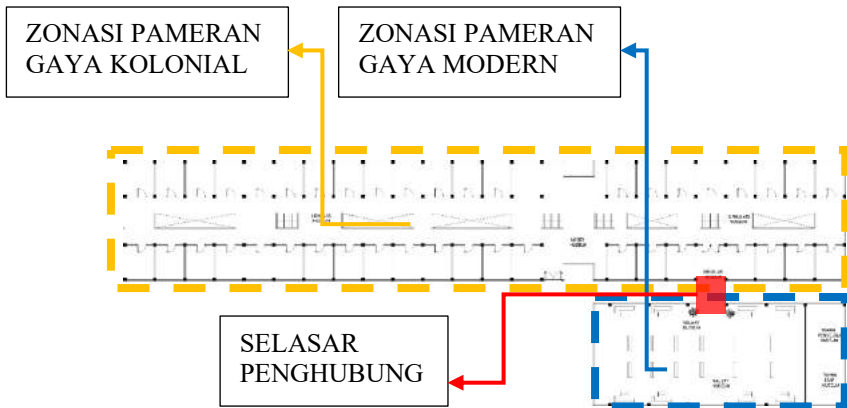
Blok Plan Museum Tai Kwun Hong Kong
